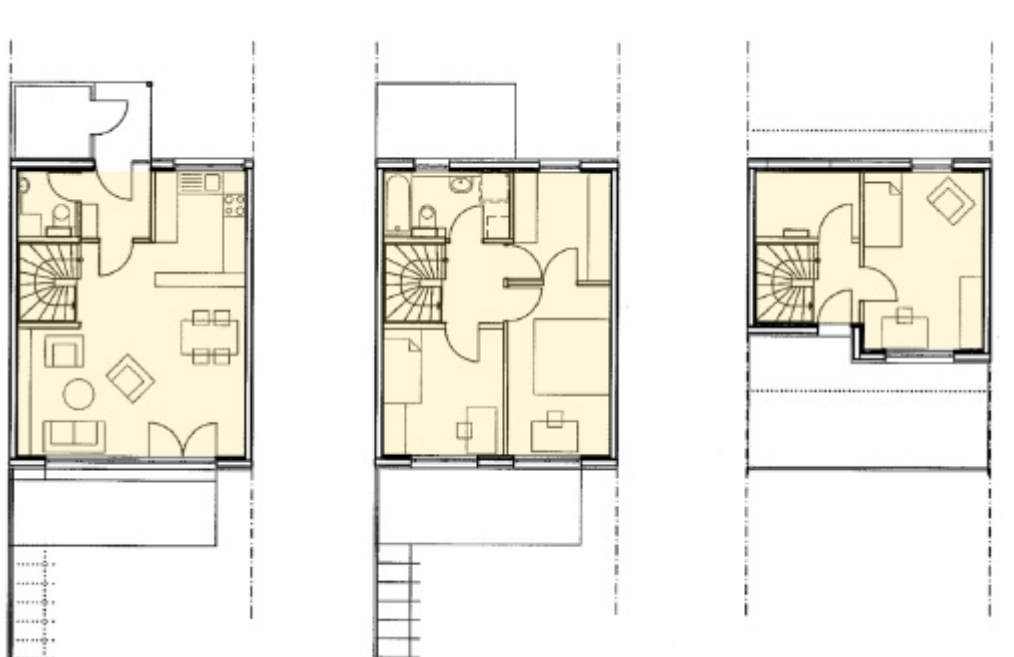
Typ A, Grundrisse EG, OG und DG, M 1:200
